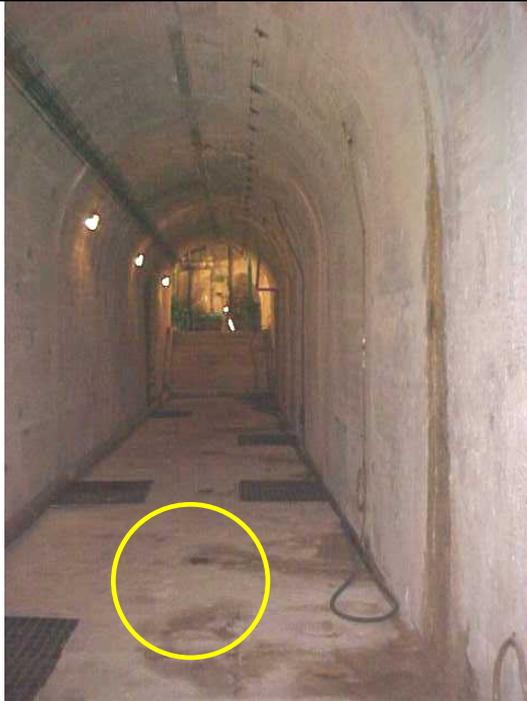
Drenes en galería inferior de la presa de Amadorio.
